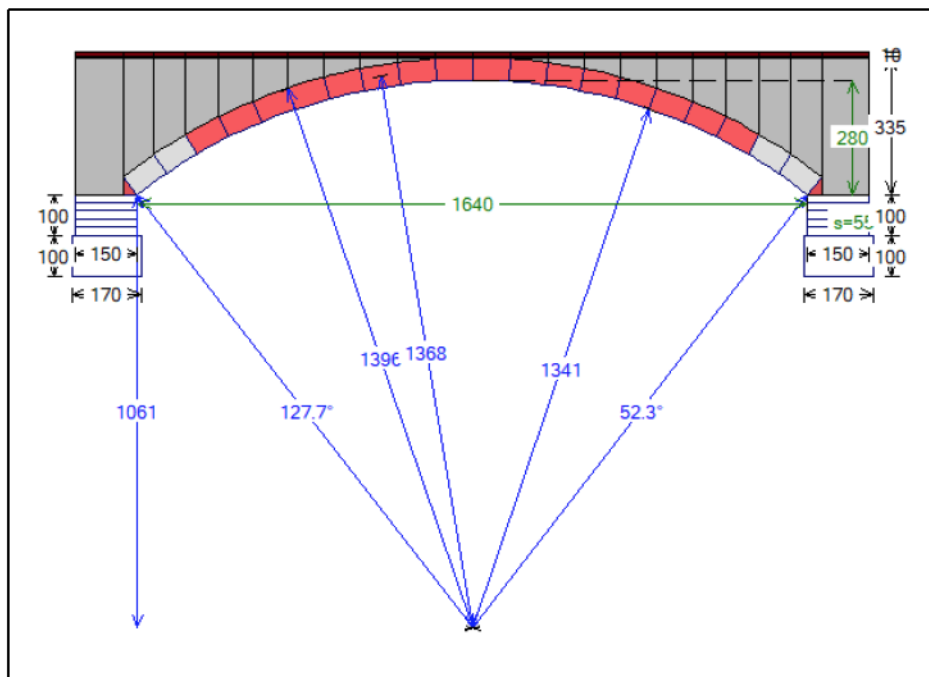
Geometria degli elementi portanti in muratura (cm) con rinfianchi e rappresentazione schematica del sottofondo e della pavimentazione.
